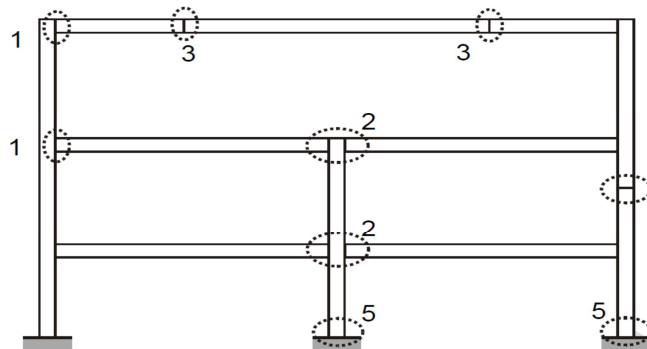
Tipos de ligações numa estrutura metálica corrente [1]
